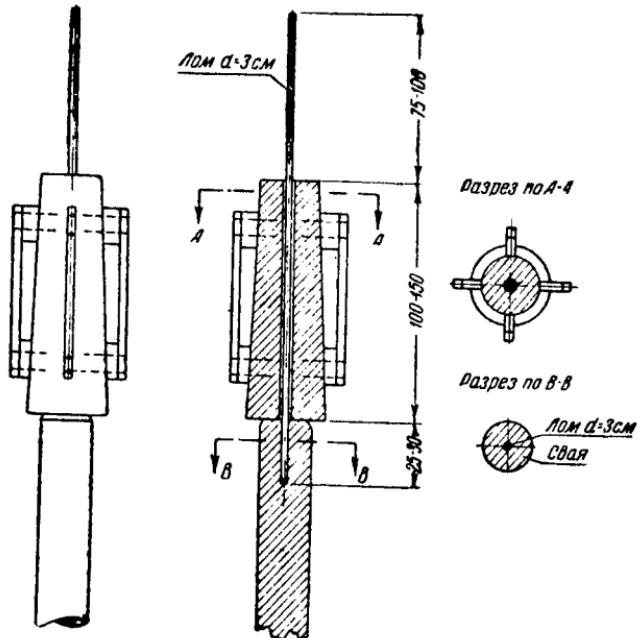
Забивка ручной бабой свай, снаженной бобышками и коротышами
